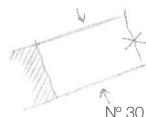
Boceto en planta de la construcción situada en la Avenida Castelao-Coia, nº 30 (autoría propia).
